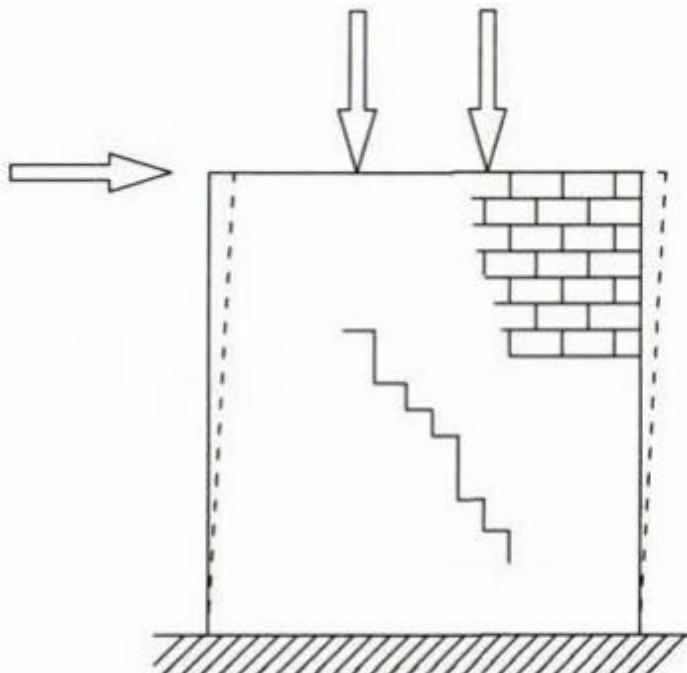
Exemplo de trinca em junta de argamassa devido ao cisalhamento (escorregamento)
